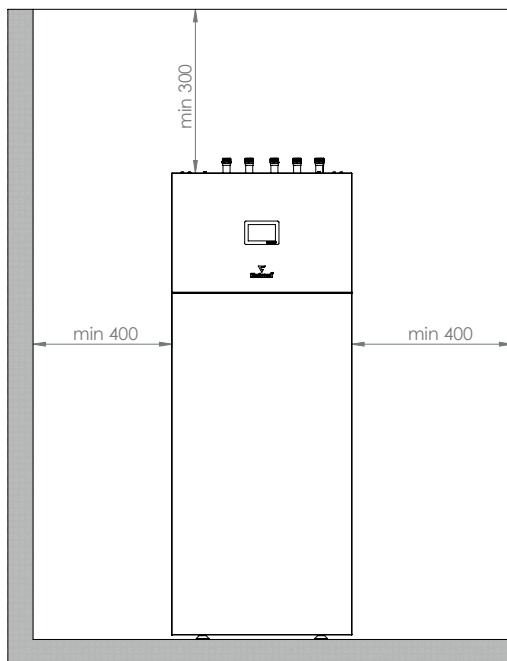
Montageabstände für das Onebox Hydraulikmodul
